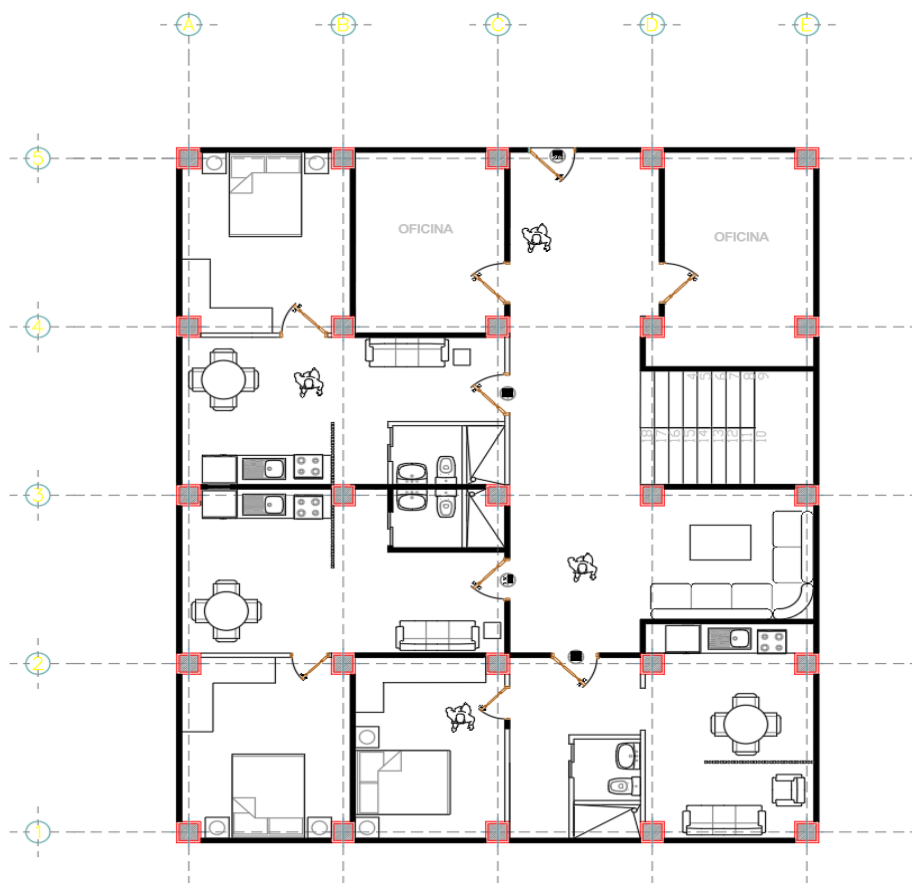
Diseño arquitectónico de la planta baja. Fuente: Propia
